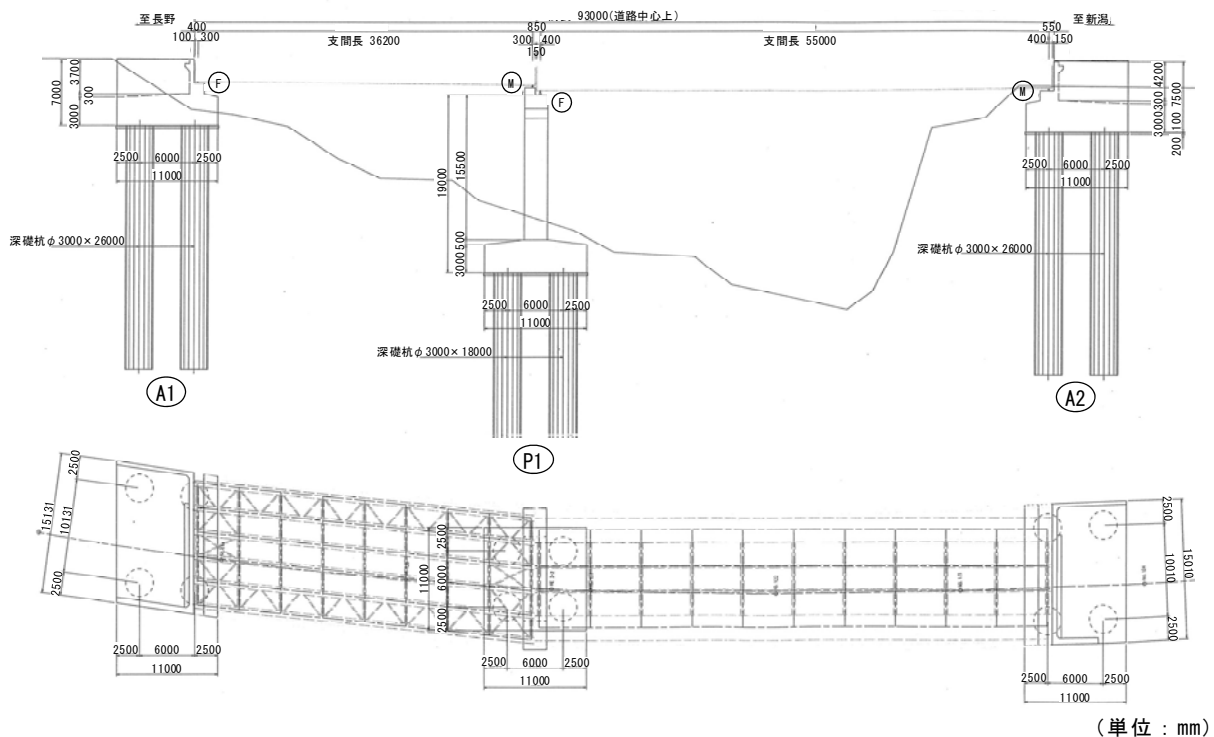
北沢橋(上:側面図, 下:平面図)
